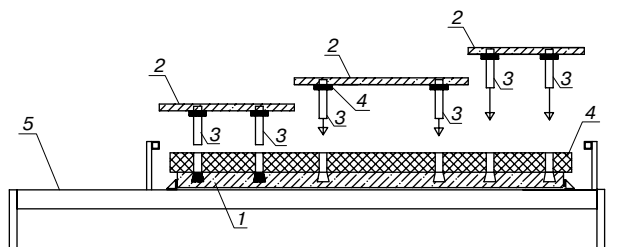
Схема сборки панели на стеллаже: 1 – внутренний слой; 2 – элементы наружного слоя; 3 – консольная связь; 4 – утеплитель; 5 – монтажный стеллаж
